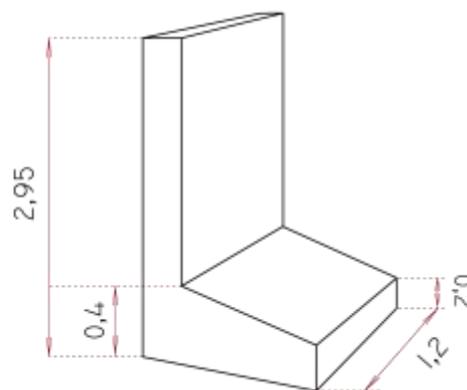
Подпорные стенки для штабелей угля
